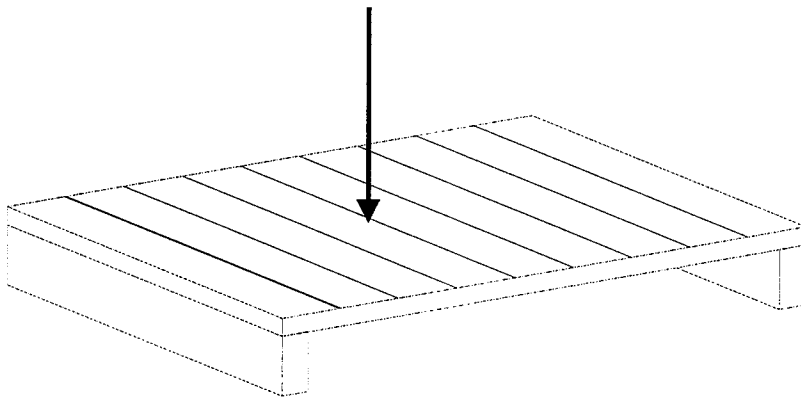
Scherung in Plattenebene (rolling shear), Faserrichtung der Decklage rechtwinklig zur Spannrichtung
